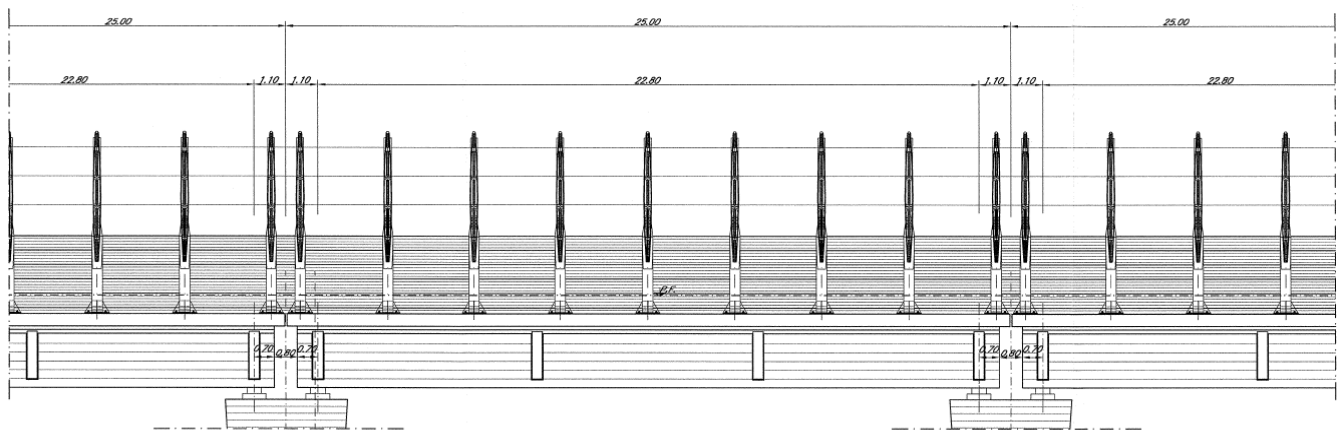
Prospetto tipo viadotto c.a.p. L=25.00m
